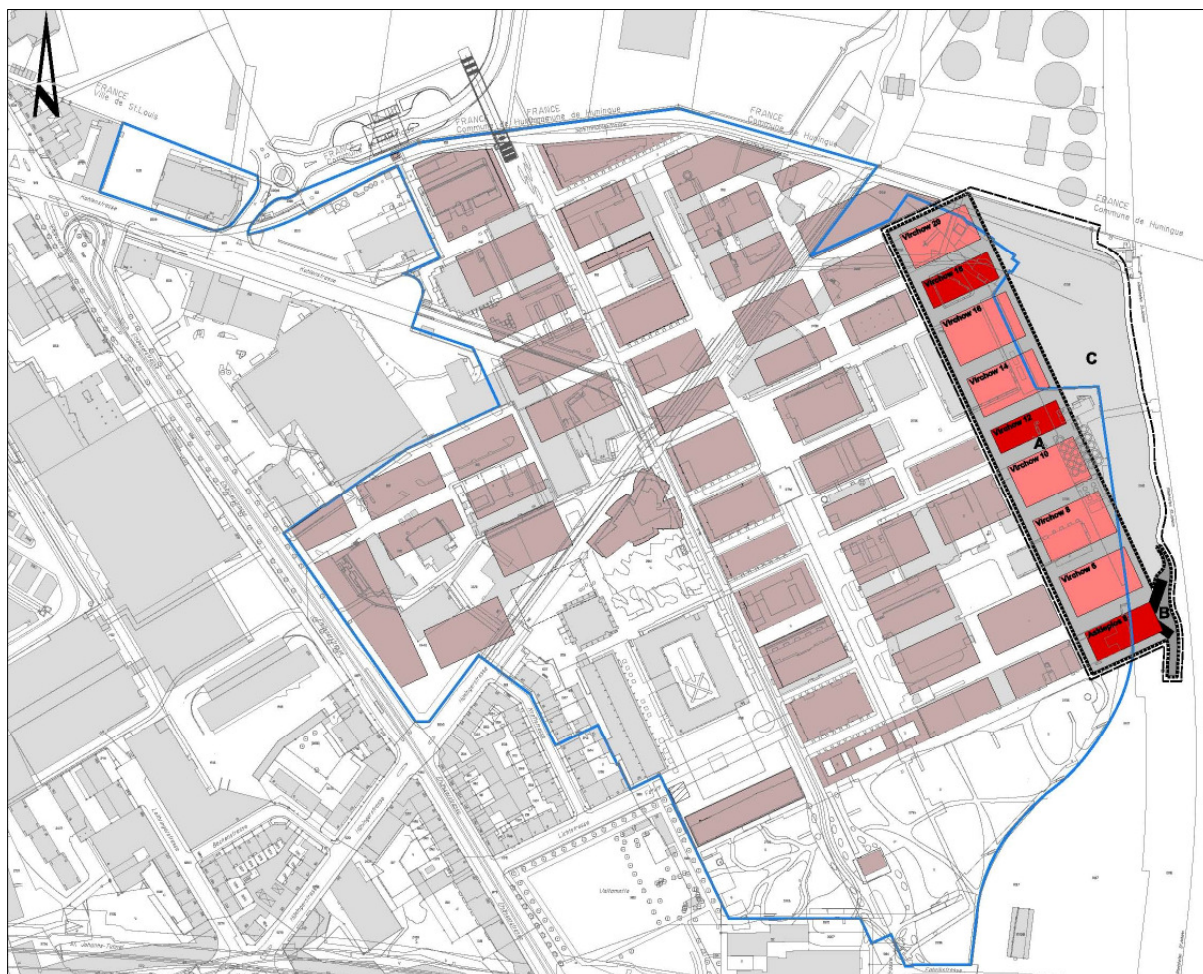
Bebauungsplan, Plan Nr. 13'572. (Nicht massstäblich, Plan genordet)
